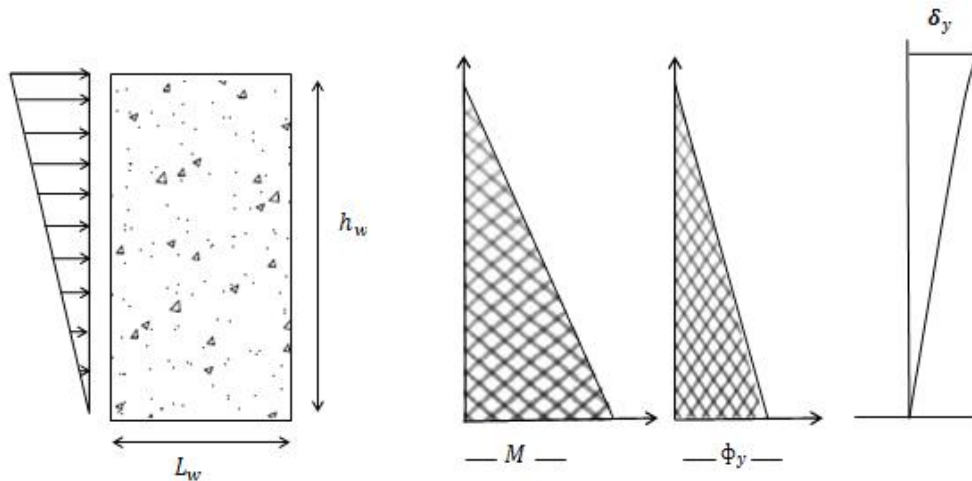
Modelo simplificado de muro completamente agrietado.
